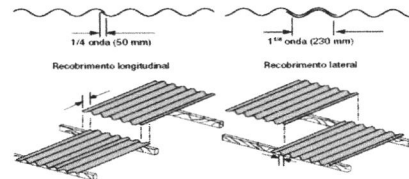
Recobrimentos lateral e longitudinal em telhas de fibrocimento
